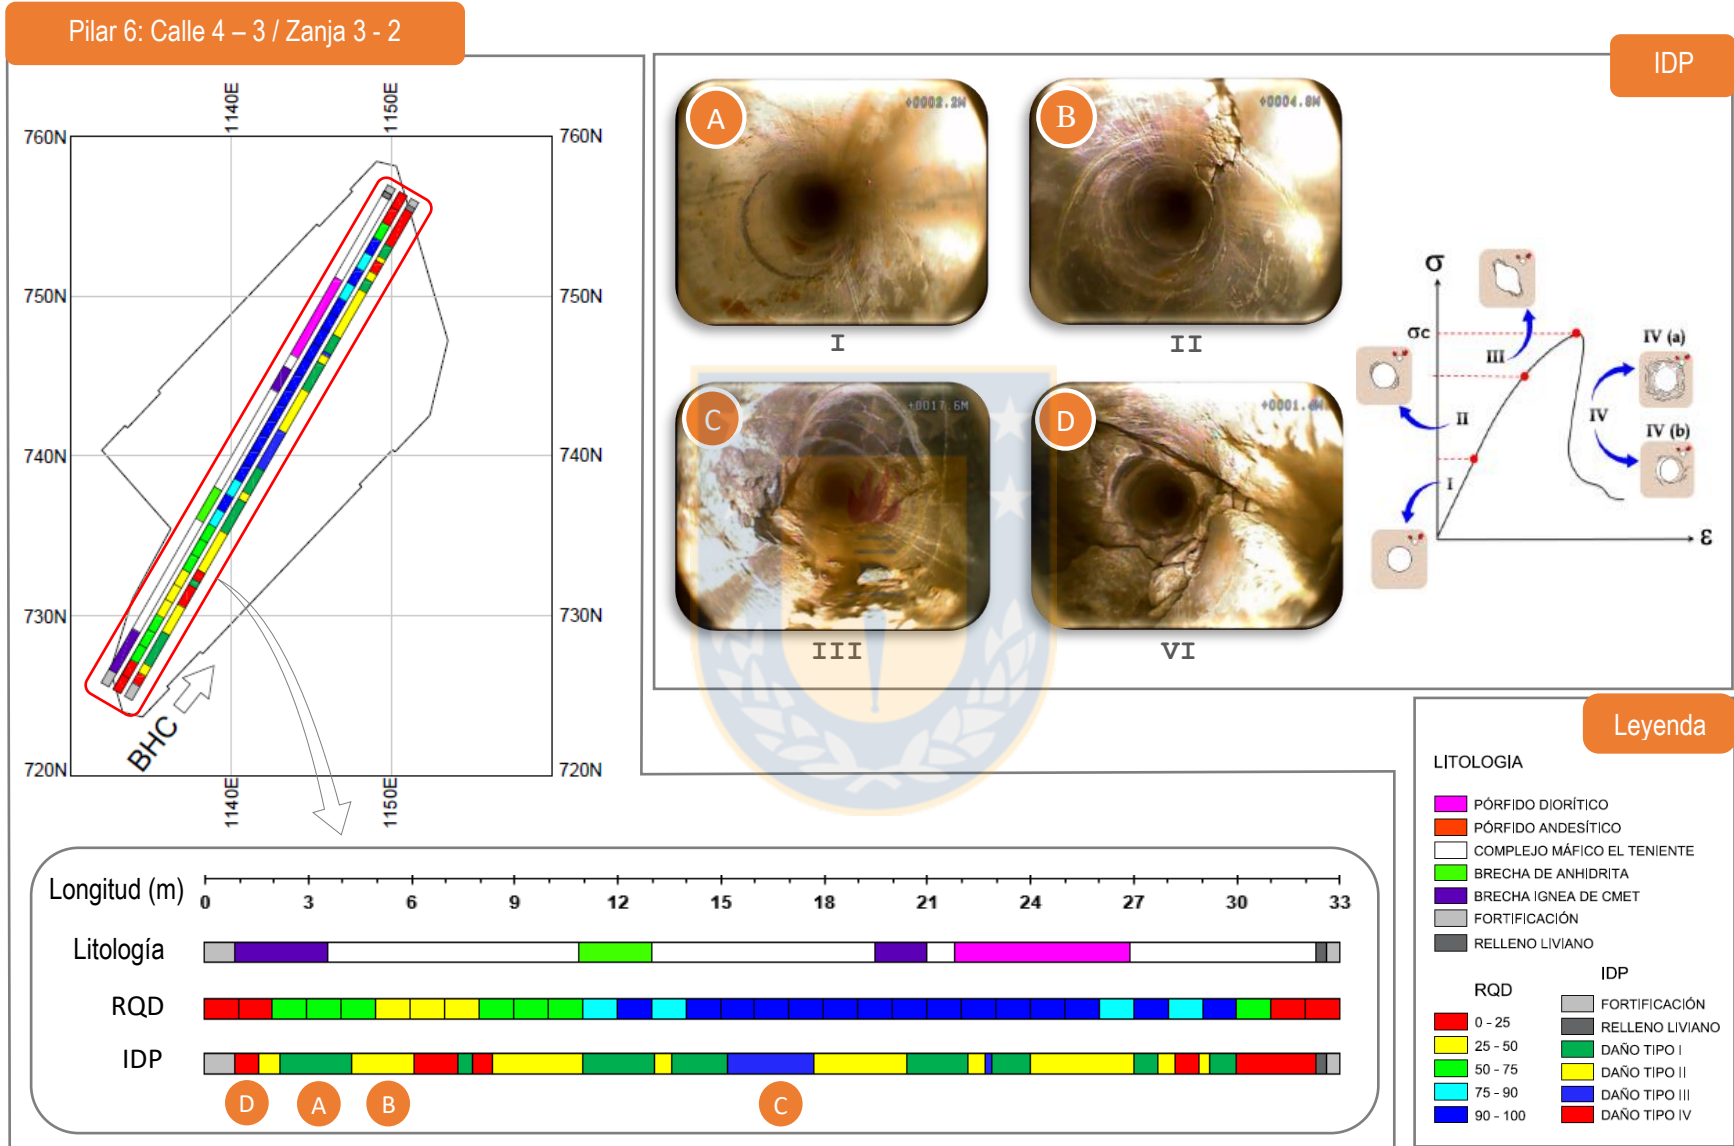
Ficha de auscultación Pilar 6: Calle 4 – 3 / Zanja 3 - 2.
